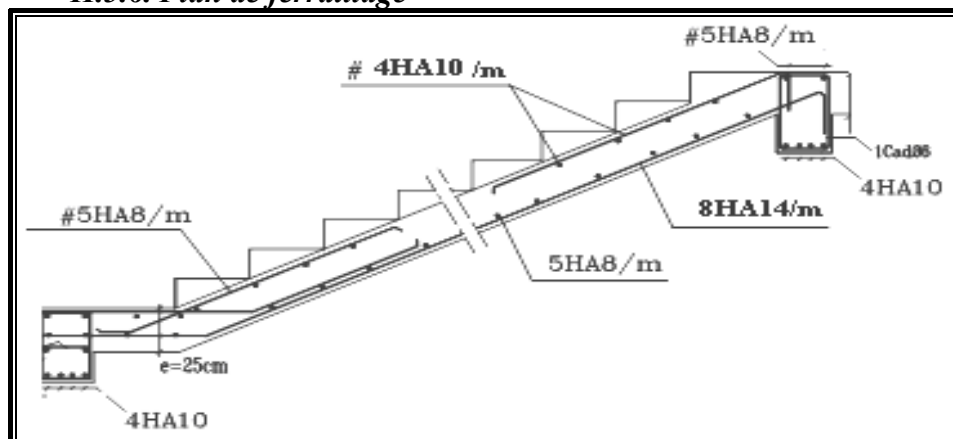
Plan de ferraillage _escalier type1
